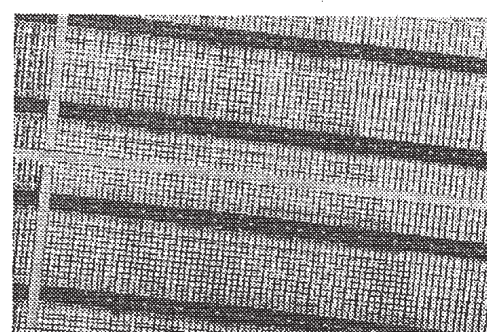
鉄筋配置設計図に合致した床版鉄筋航空画像
